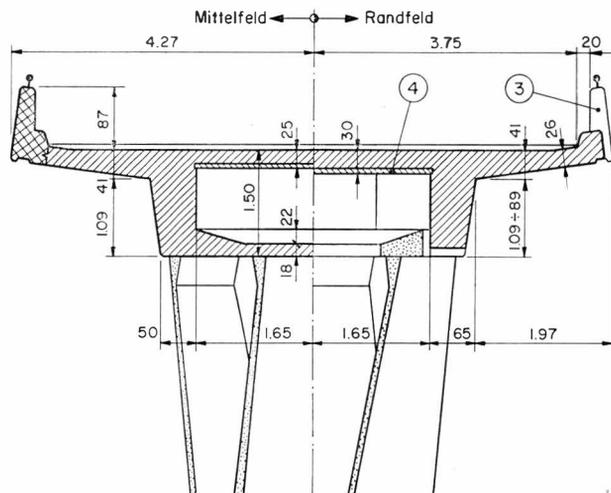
Querschnitte. Links Mittelfeld, rechts Randfelder. 3 Brüstungselement, 4 Betonbrett
